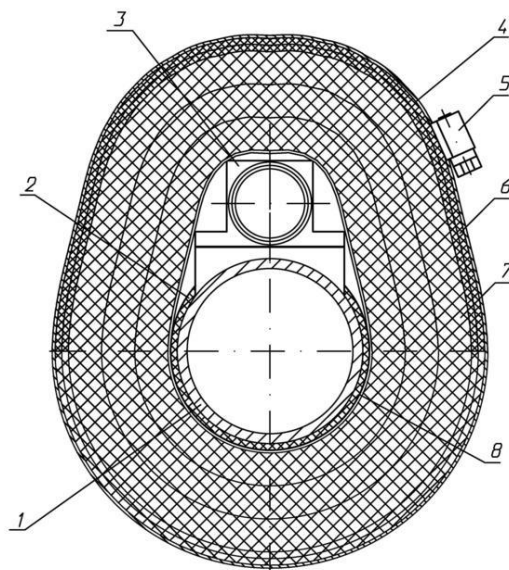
Схема установки и крепления ТС.П на трубопроводе
